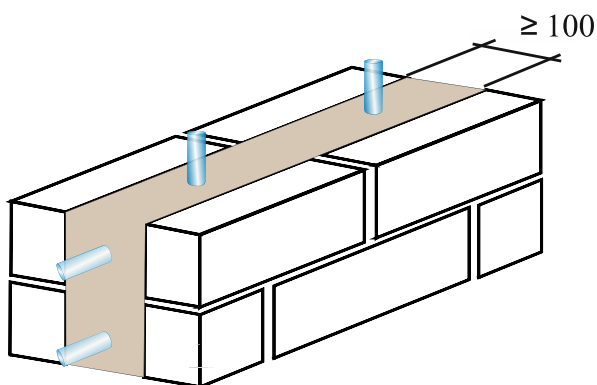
Расположение горизонтальных и вертикальных арматурных стержней в заполняемой бетоном щели многослойной кладки [10]
